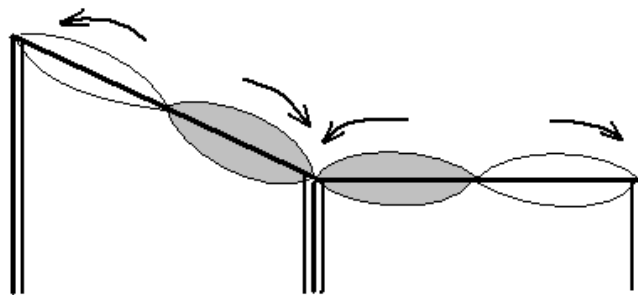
Схема передачі снігового навантаження на колони будівлі
